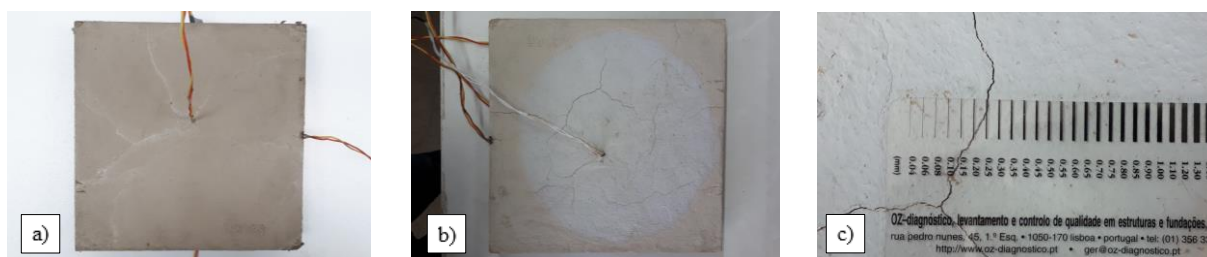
Provete P_A2_2_MI: a) Provete antes do ensaio; b) Provete após o ensaio; c) Fissuração do provete após o ensaio.
